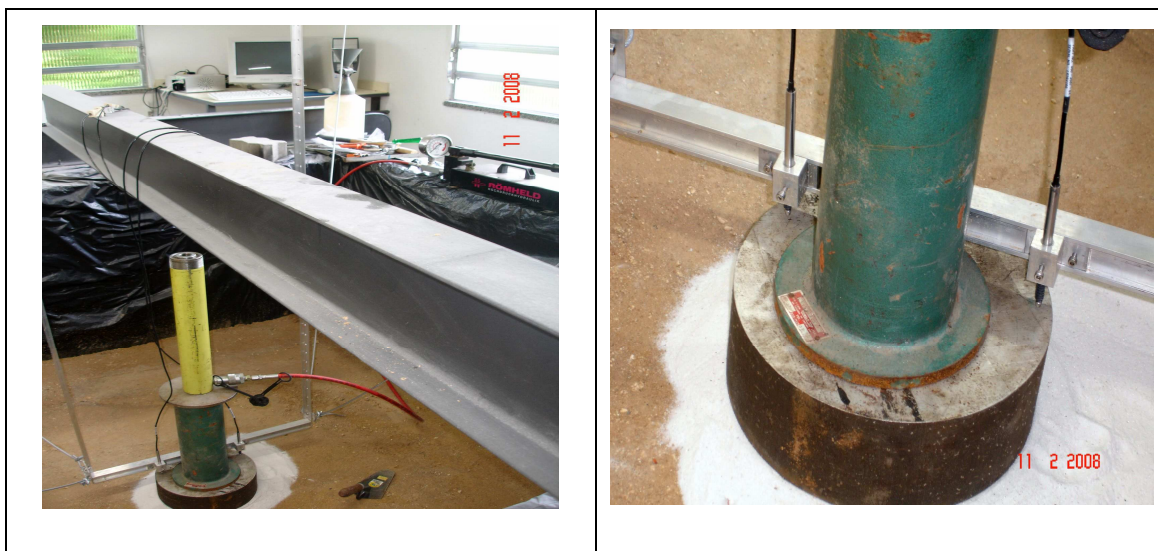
Conjunto macaco, viga suporte, espaçador para aplicação de carga, placa e suporte dos LVDTs.
